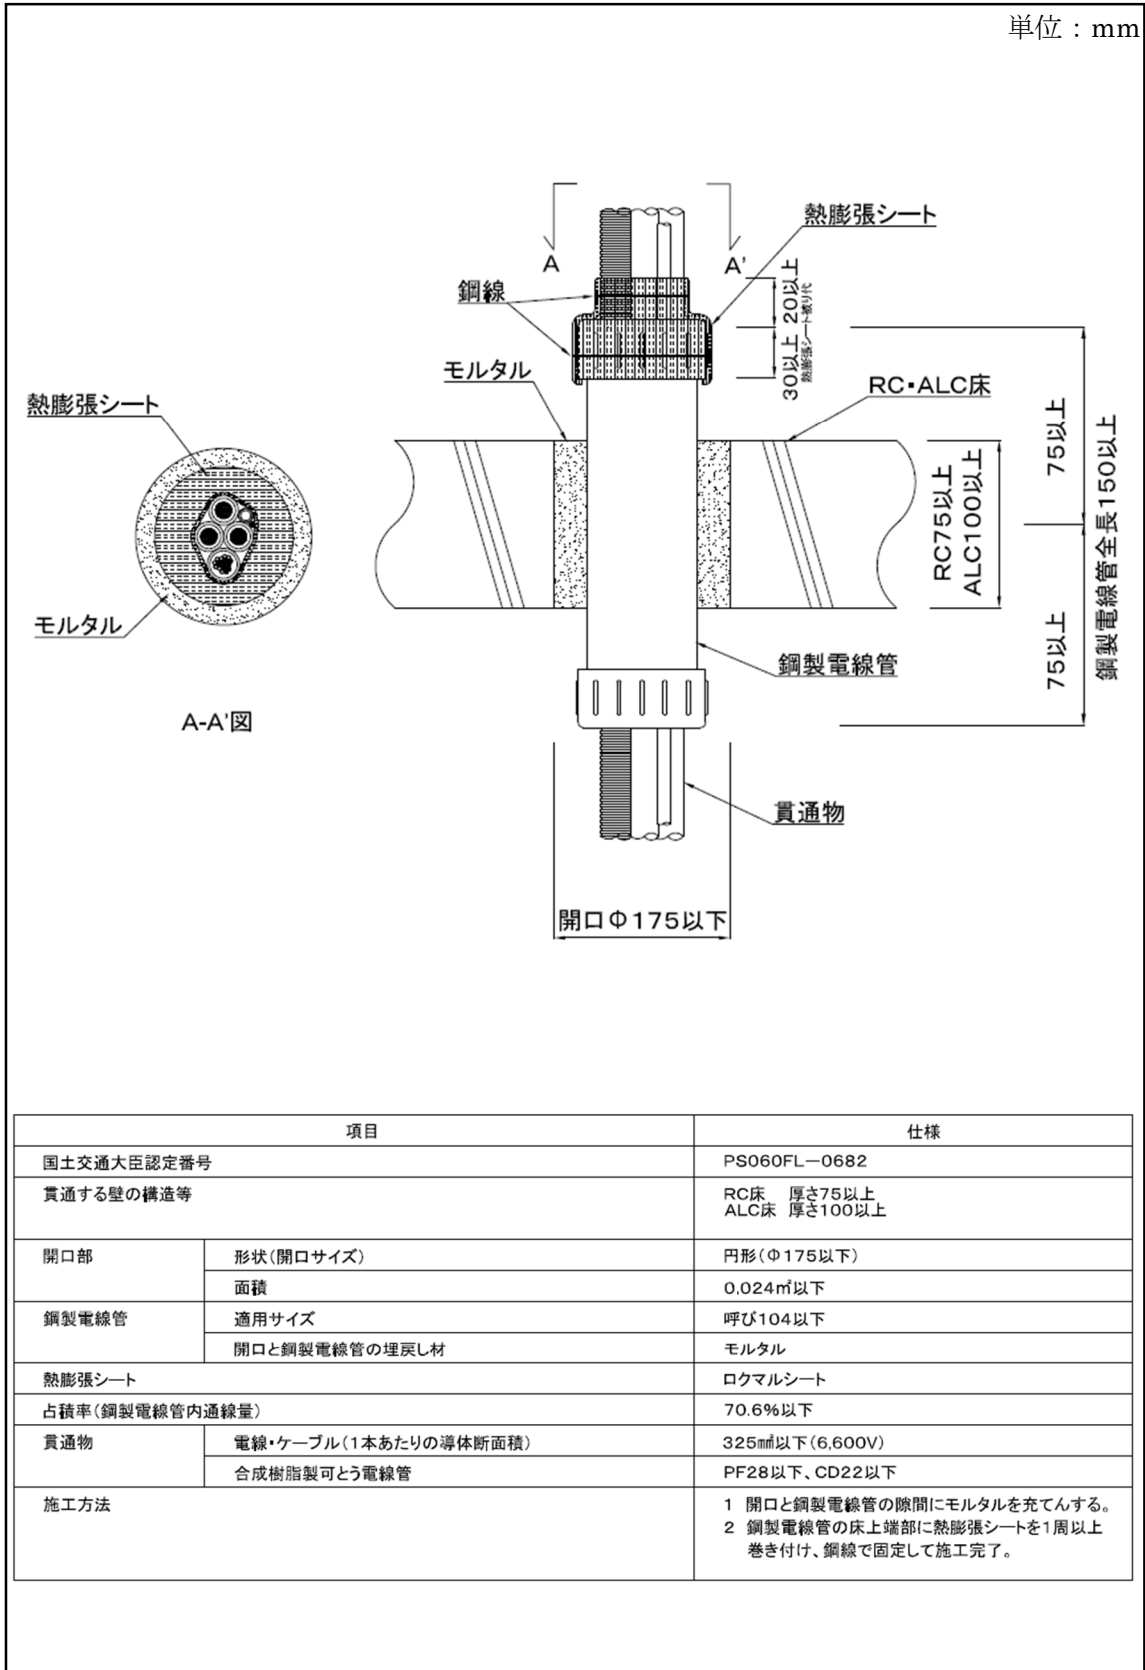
鉄筋コンクリート・ALC 床(PS060FL-0682) 標準施工図
